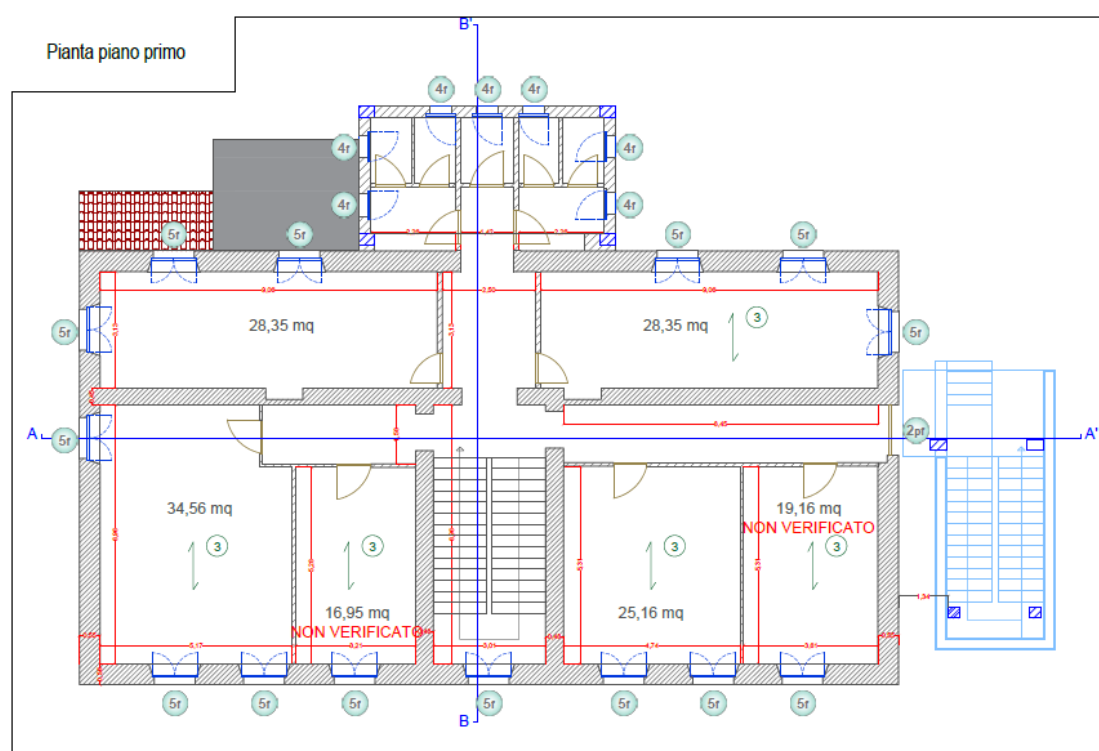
Planimetria Piano Primo con individuazione delle tipologie di solaio
